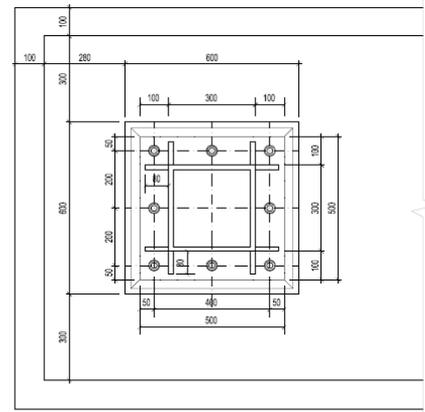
Pensiline – Dettaglio nodo di fondazione
